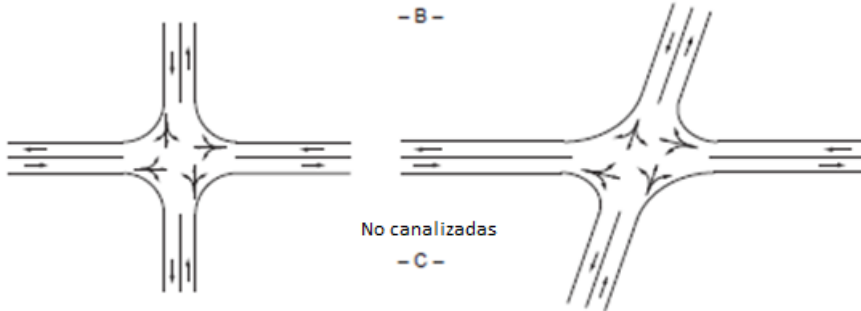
Tipos Generales de Intersecciones.
